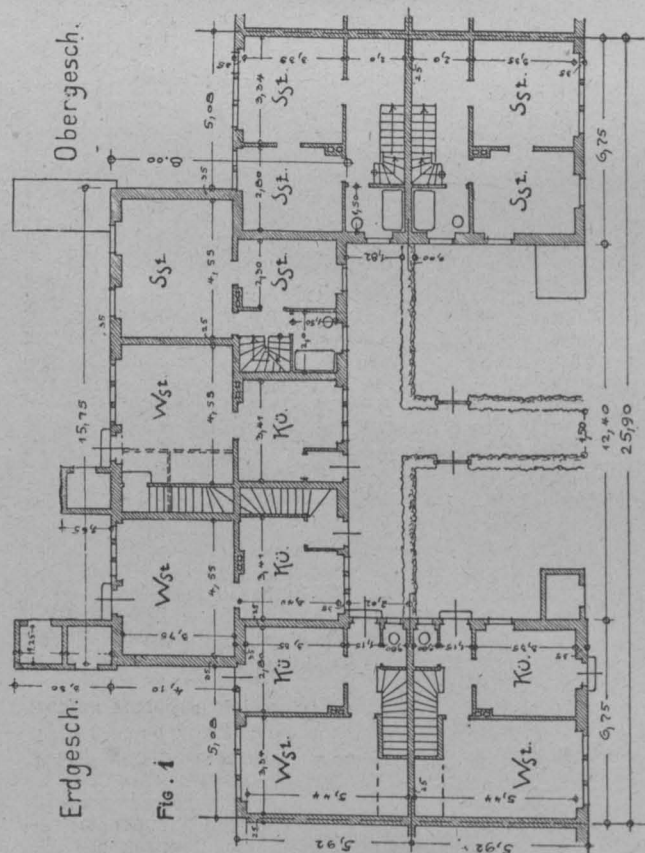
Nach Maßen aufgetragene Grundrisse einer Wohnhausgruppe nach Abbildung 8 des Buches.
